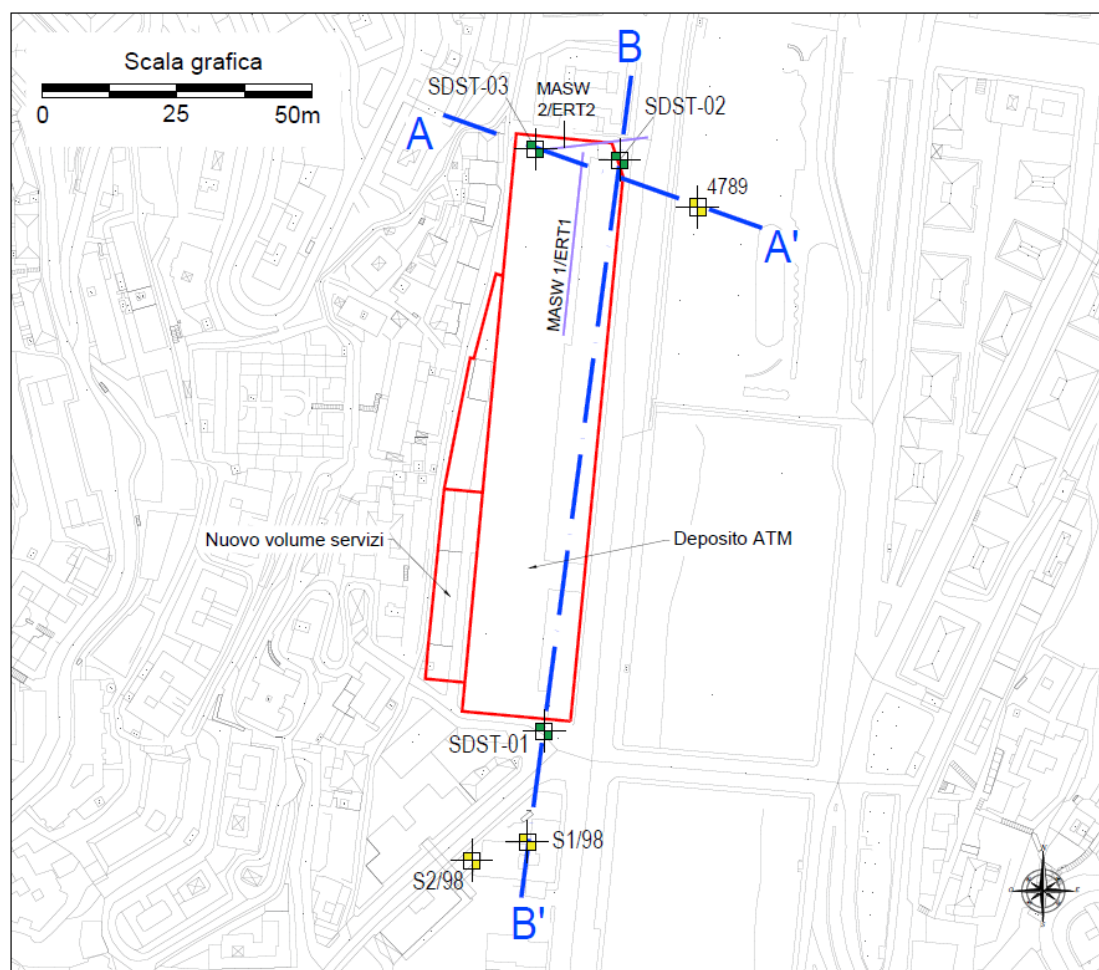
Pianta su base topografica con indicazione delle prove in sito e dell'ingombro dei nuovi edificati. In blu la traccia dei profili geotecnici eseguiti.
